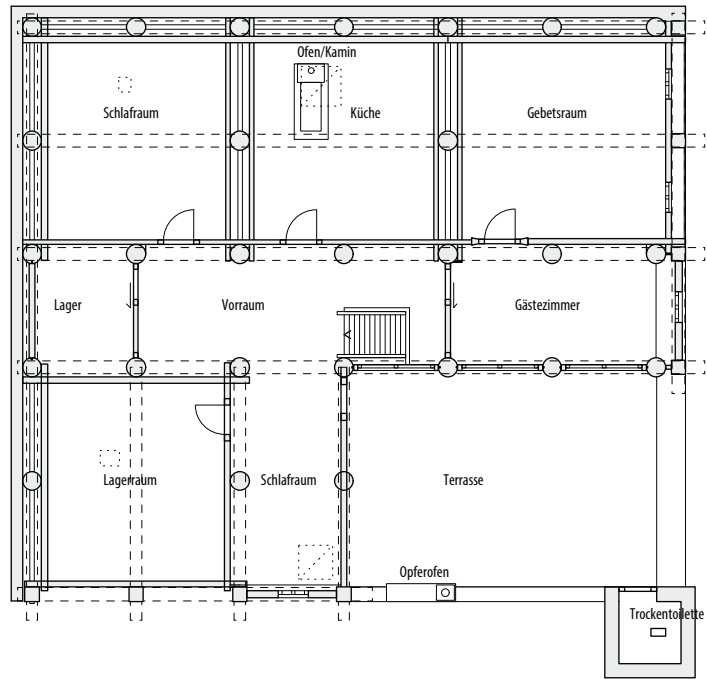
Grundriss erstes Obergeschoss. Haus Yalo.
